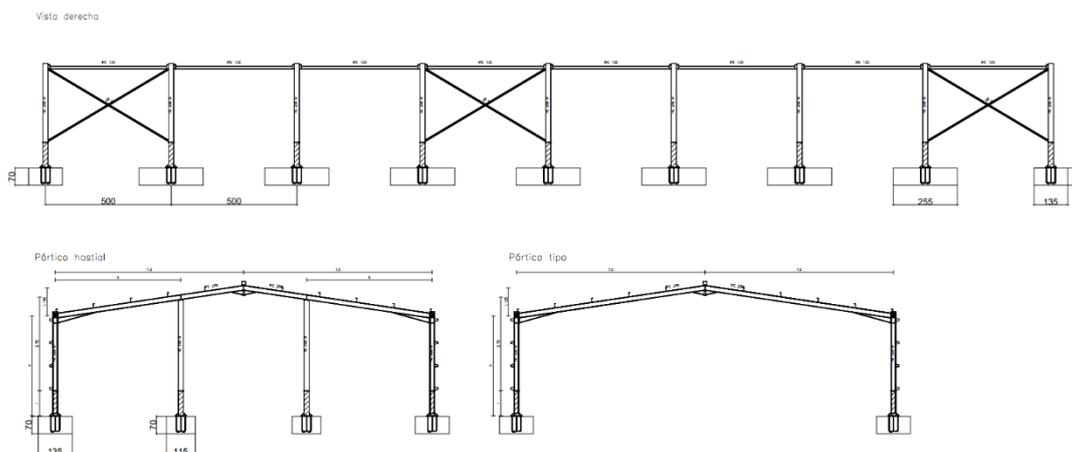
Estructura metálica. Fuente: elaboración propia.
